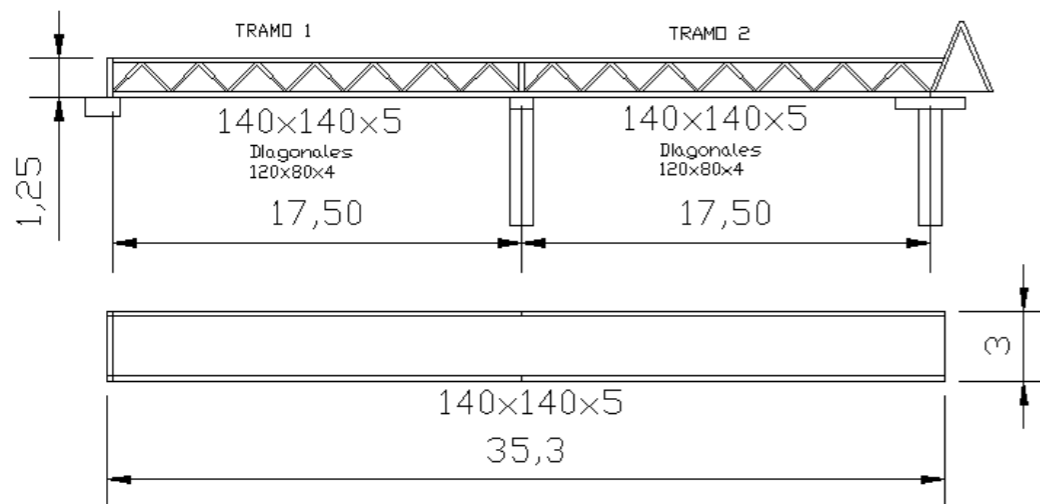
Alzado y planta superior de los tramos 1 y 2.
